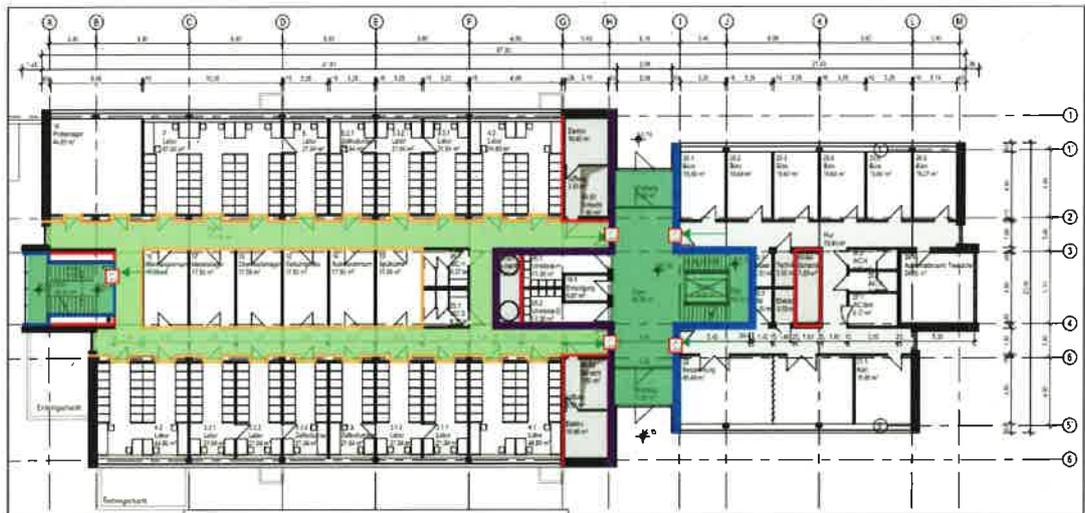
Grundrisslayout - Schematischer Brandschutzplan
